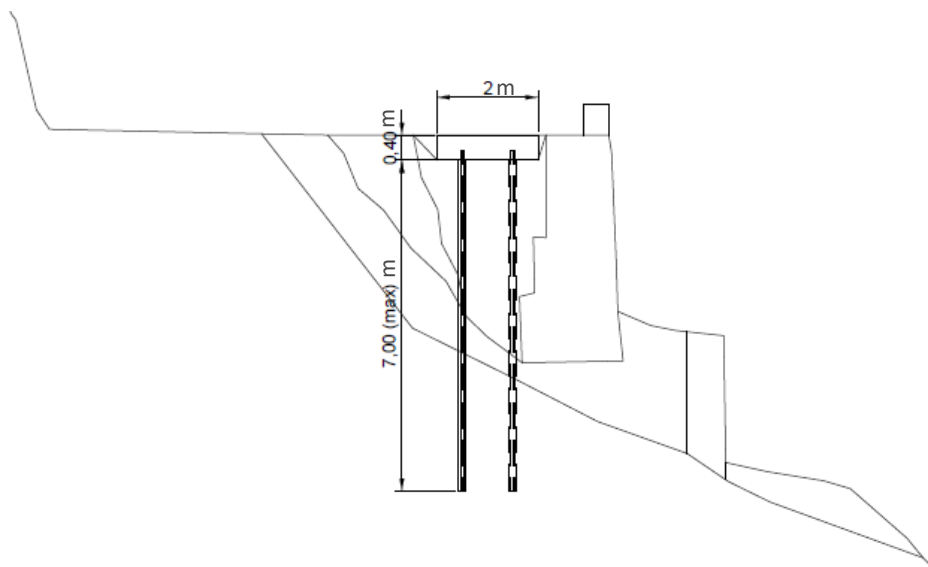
Croquis en alzado de la solución de cimentación profunda de los apoyos de la grúa.
